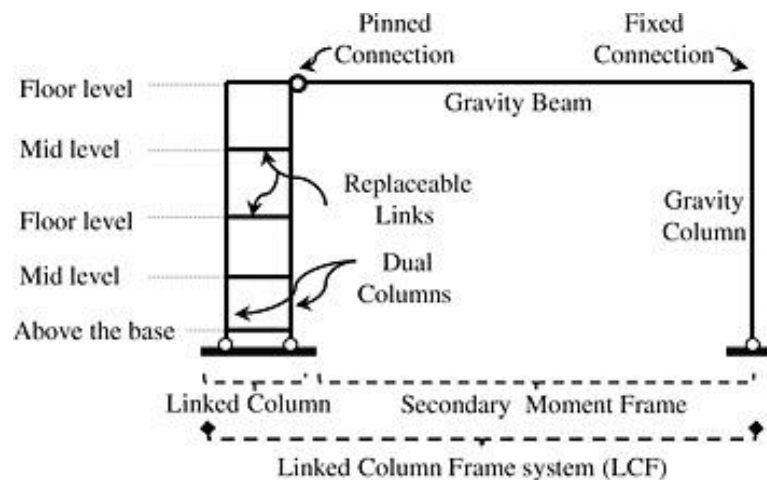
Linked Column Frame system (LCF) (Malakoutian et al., 2016)
